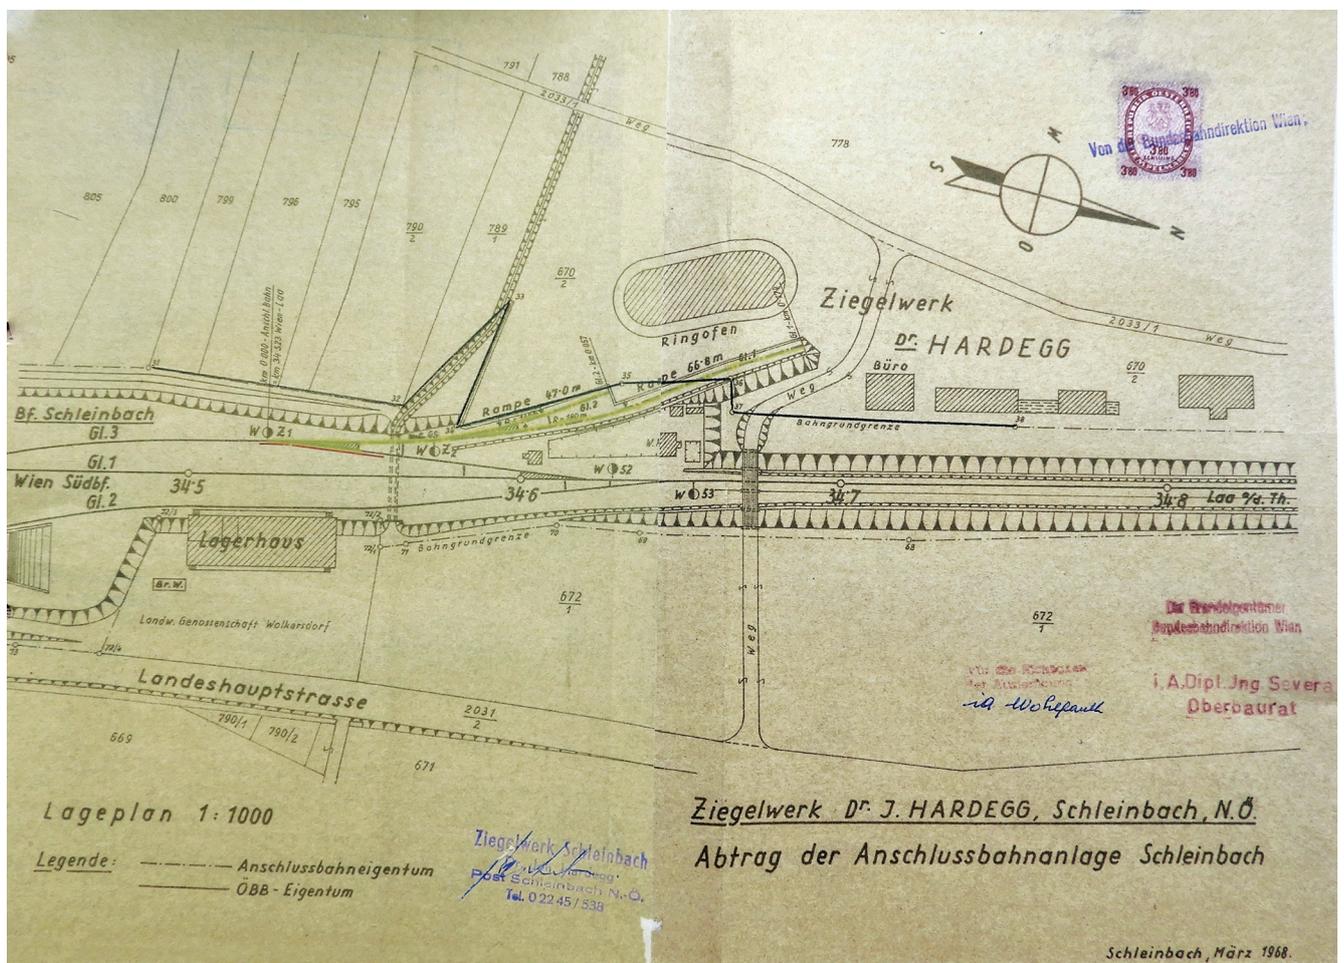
Lageplan des „Ziegelwerkes Dr. J. Hardegg, Schleinbach, NÖ.“ ca. 1968 (Sammlung Wiener Zieglmuseum).
